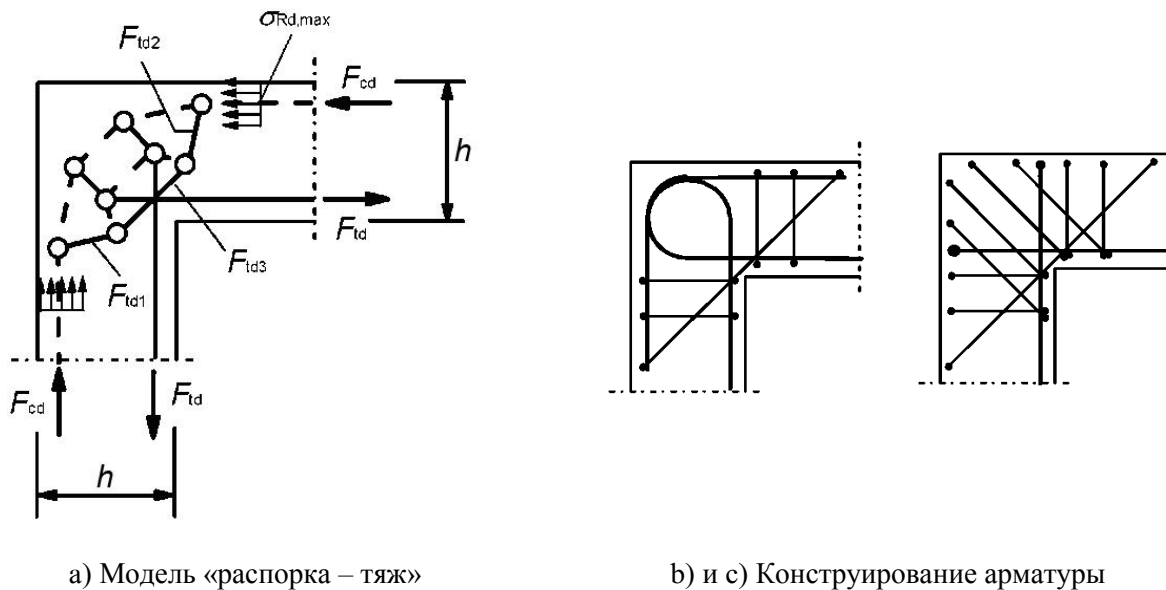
Угол рамы с большим раскрывающим моментом
